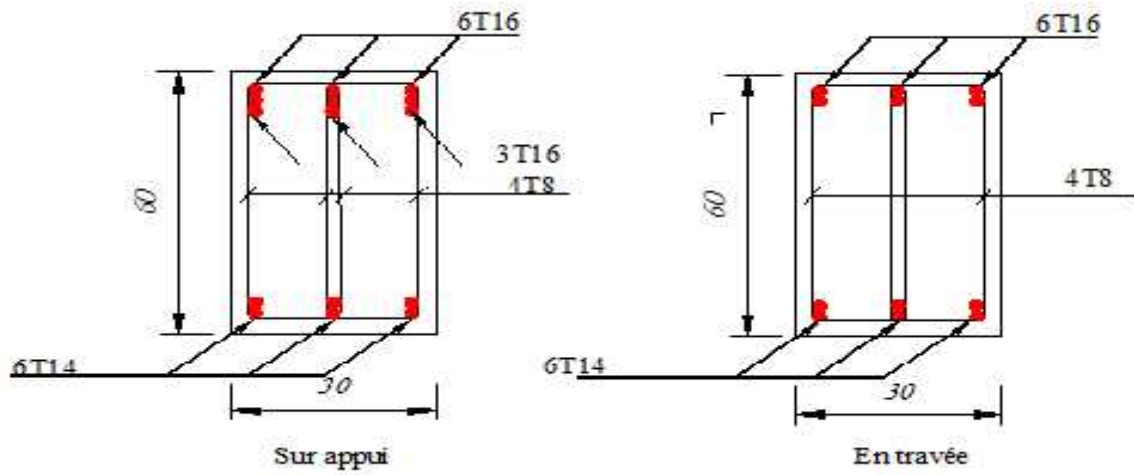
Ferraillage des poutres porteuses deuxièmes types.
